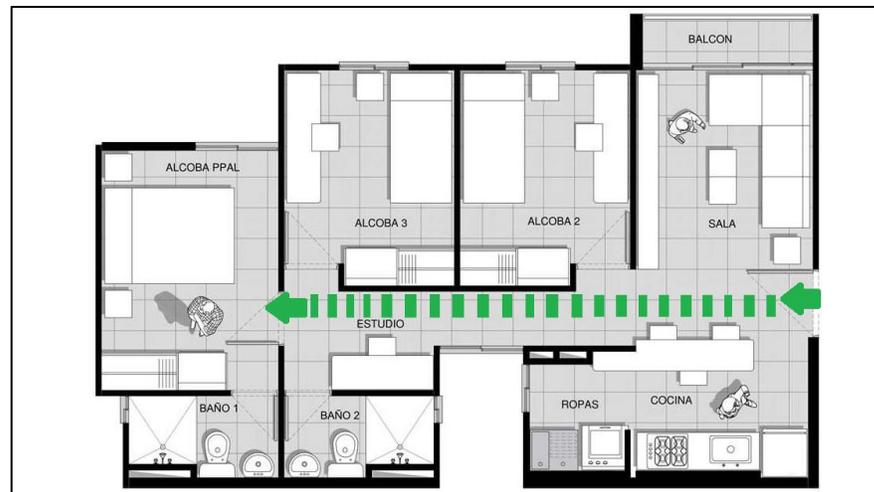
Planta apartamentos Monteverdi Etapa I
